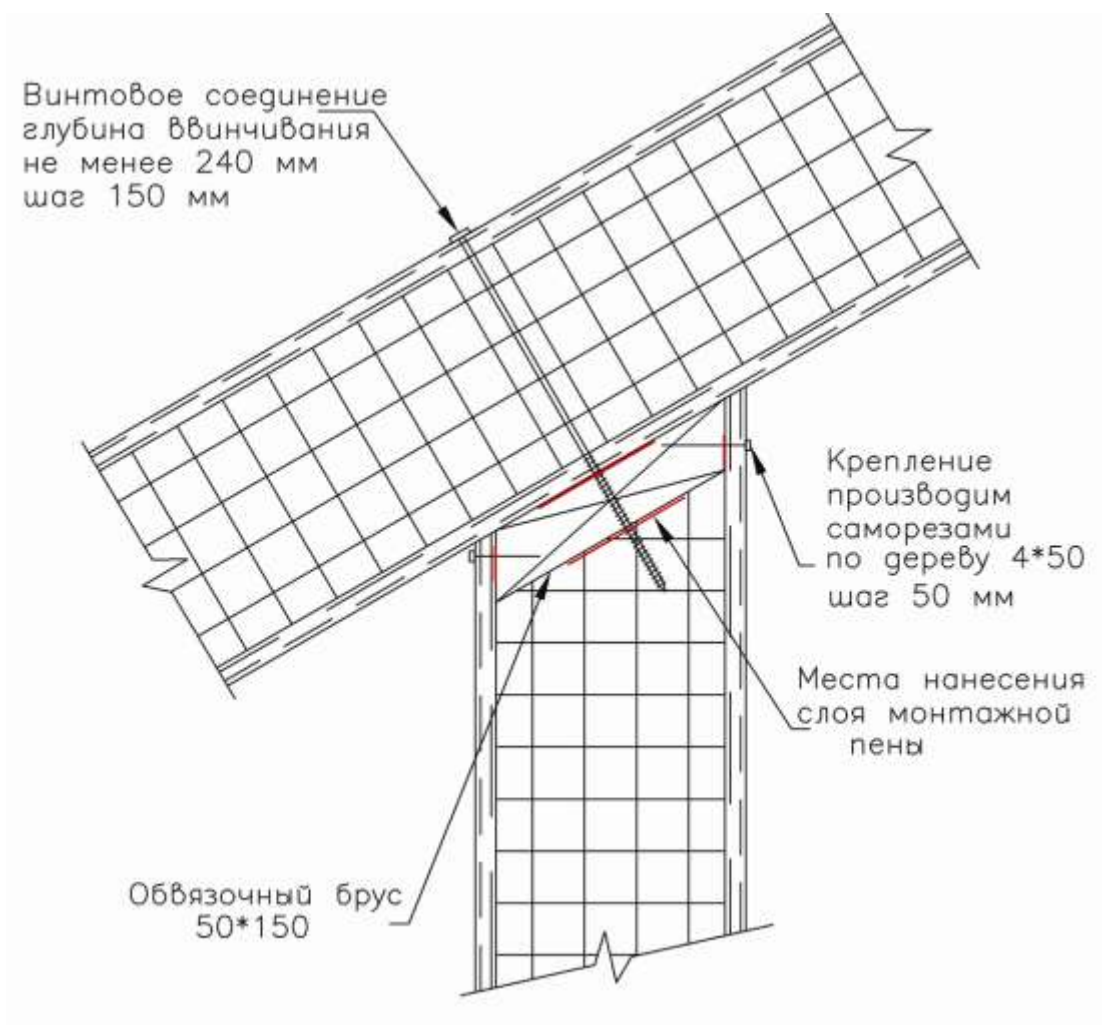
Соединение стеновой панели с кровельной. Вариант №1
